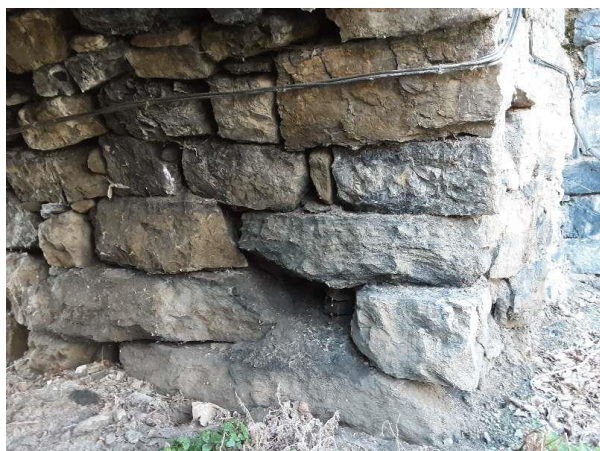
Deslavado de juntas y pérdida de sillares en estribo 1.
